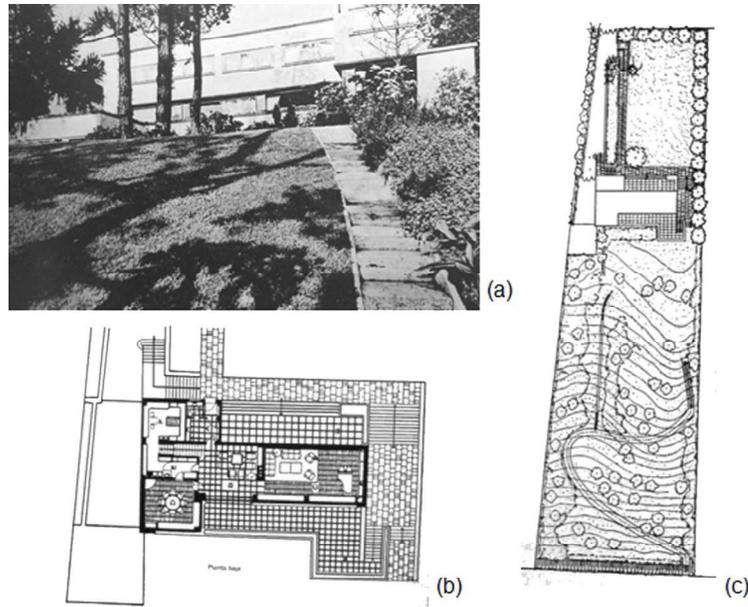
Erich Mendelsohn, Casa del arquitecto, "am Rupenhorn", Berlín, (1929): (a) Vista exterior desde el lado este del jardín en declive, (b) Planta baja y terraza, (c) Planta de conjunto.
